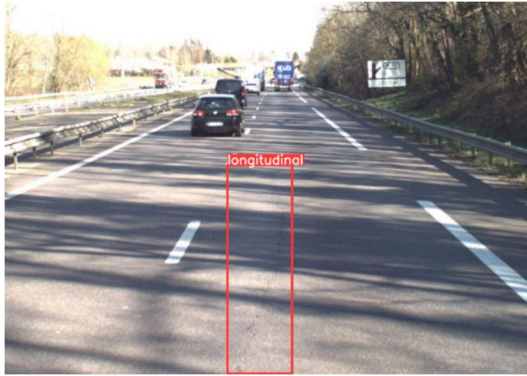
Fissure longitudinale détectée en 2023 sur la A31 au PR 294+60
